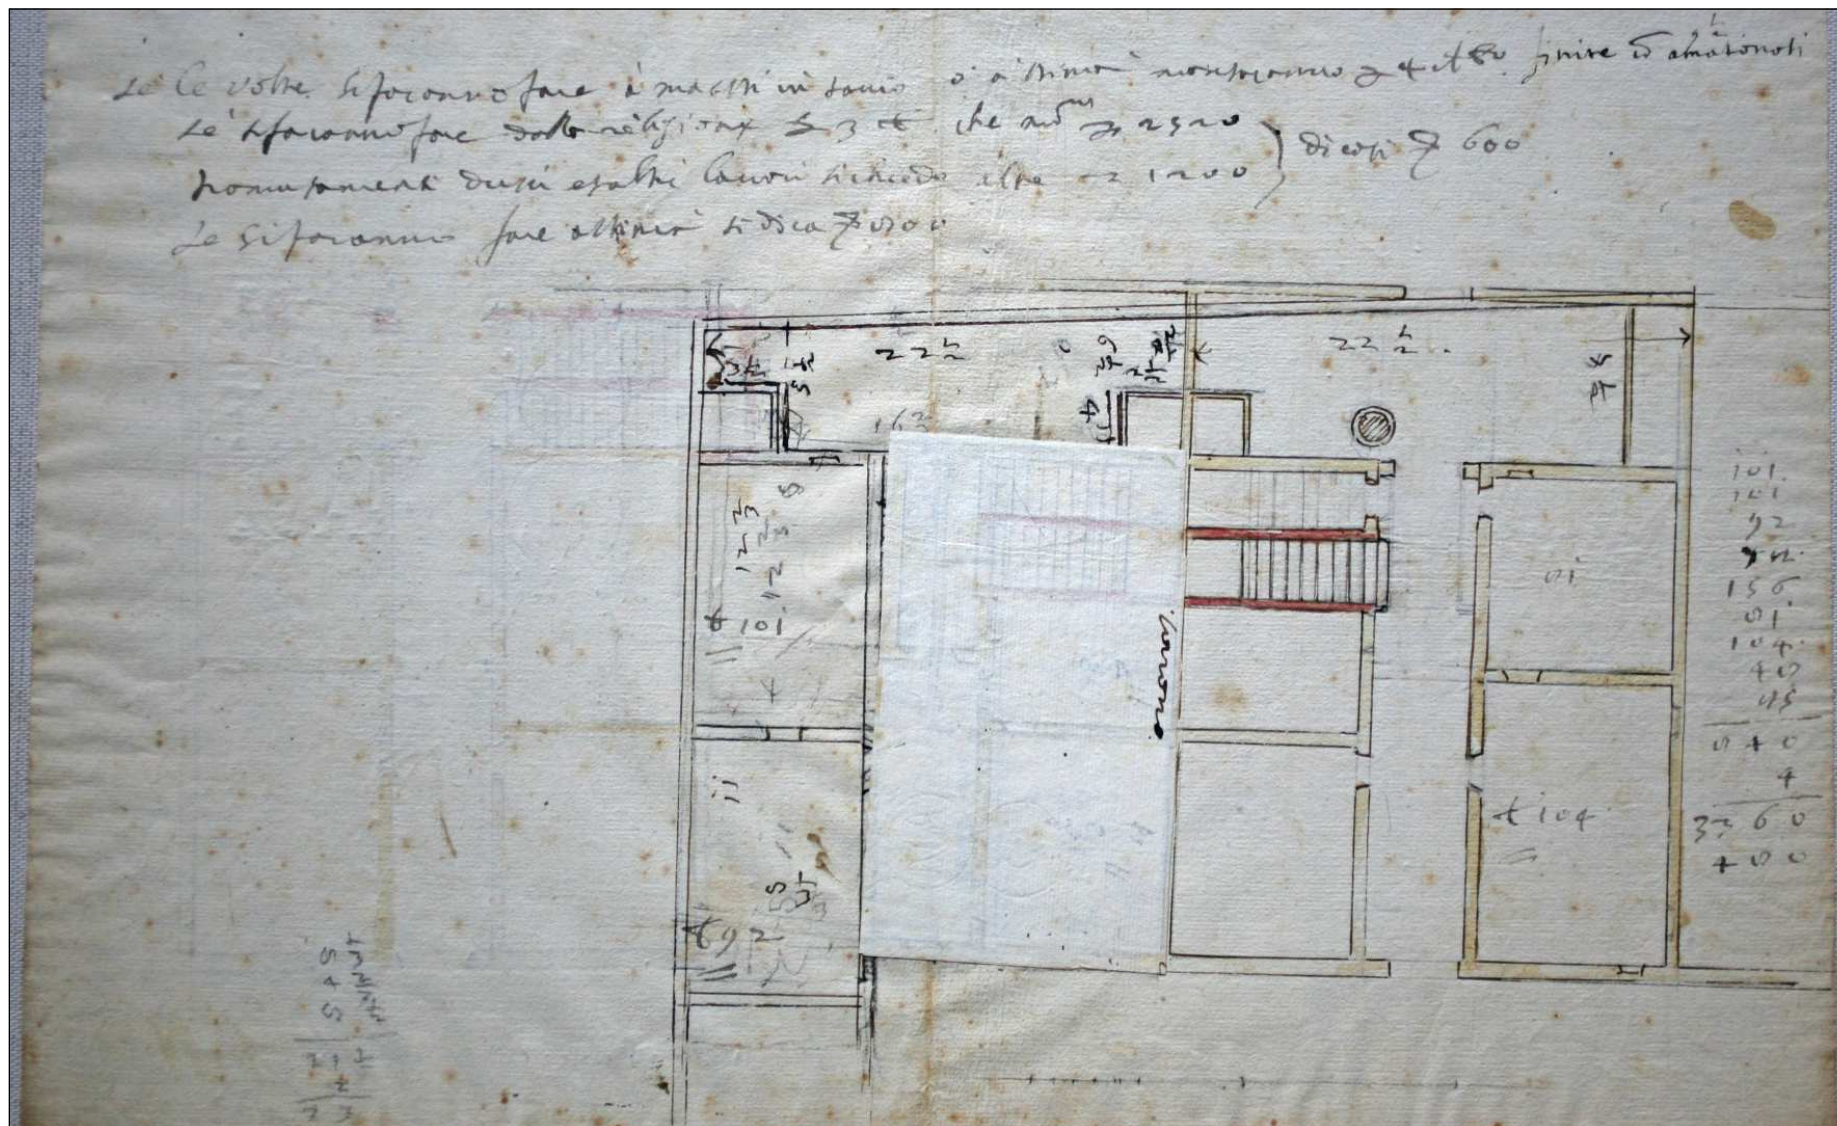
Pianta piano terra e piano primo Casa Auditoriale; 1665; ASP, OSS, f. 3214.
